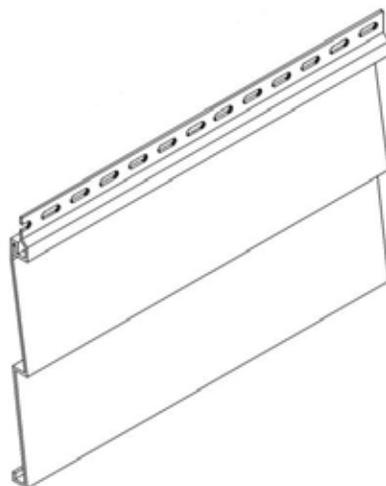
Perfil típico de siding vinílico (SANTIAGO, 2008)
